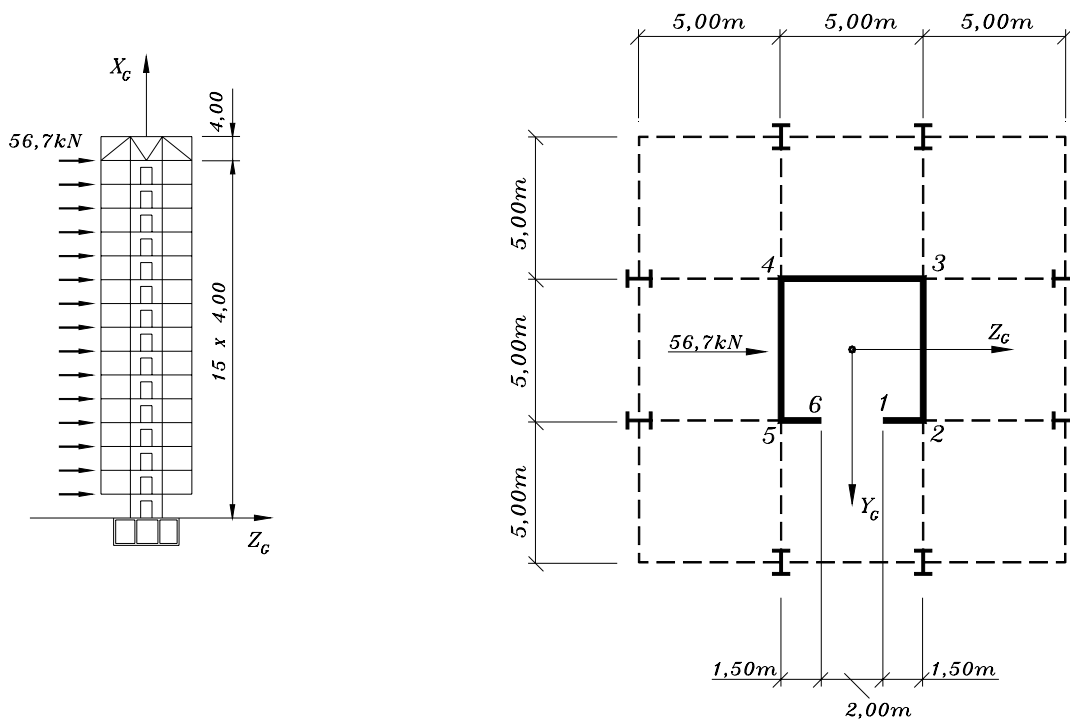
Planta baixa e corte X_g x Z_g do núcleo idealizado por YAGUI (1987).
